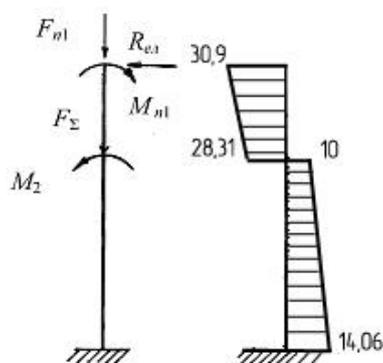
Схема для определения усилий в крайней левой колонне от постоянных нагрузок
